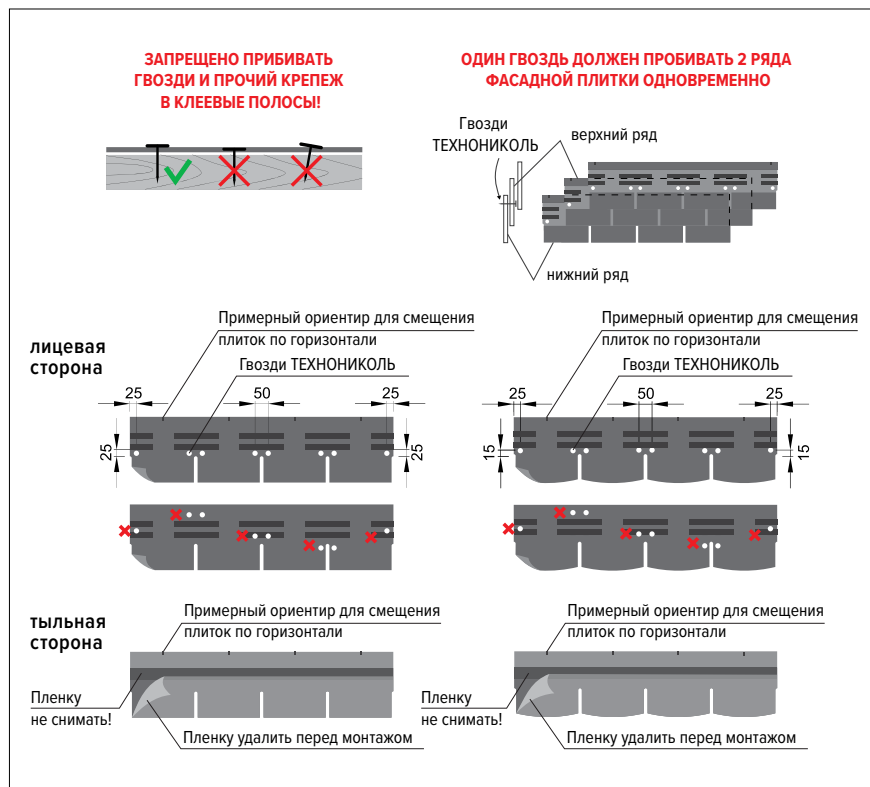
Схема крепления фасадной плитки на 8 гвоздях
